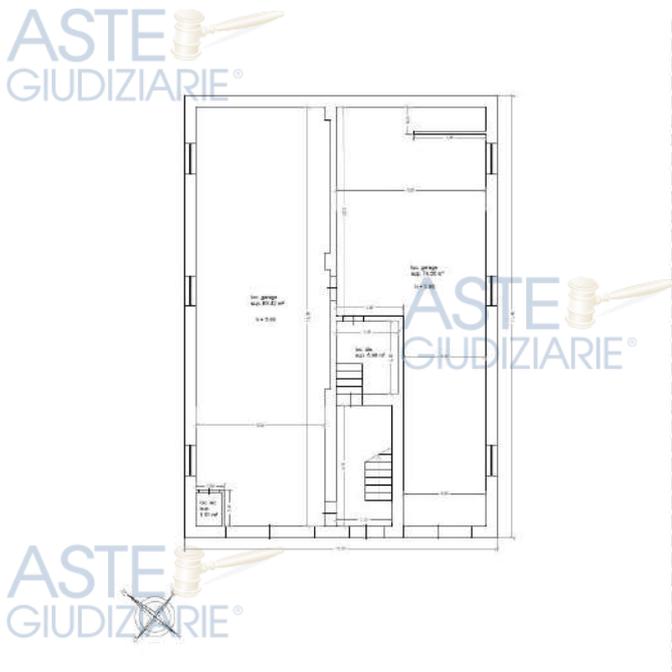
Confronto rilievo stato dei luoghi con planimetria urbanistica \_ Piano Terra (Tav. N)
